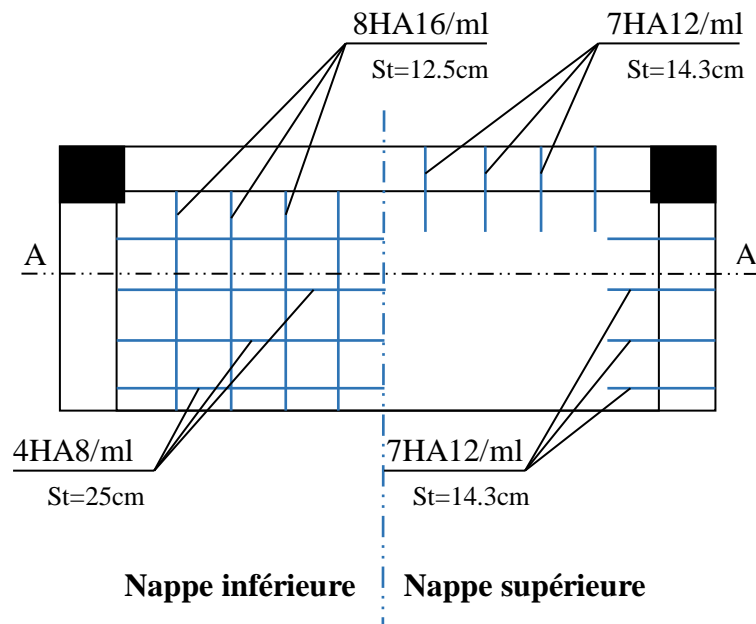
Schéma de ferrailage de panneau de dalle D7
